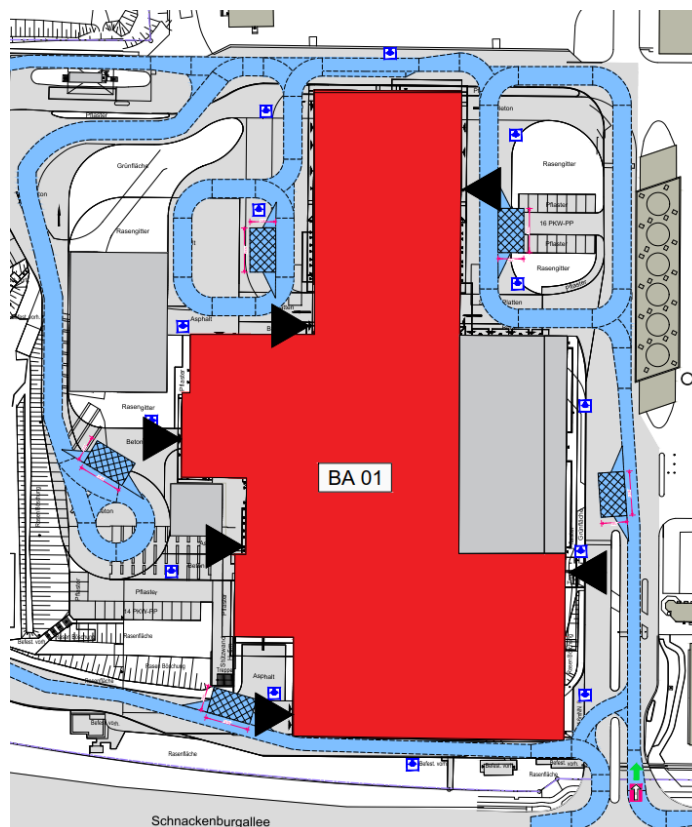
Lage Brandabschnitt BA 01 – Hauptanlage mit Hauptzugängen (Angriffswegen)
